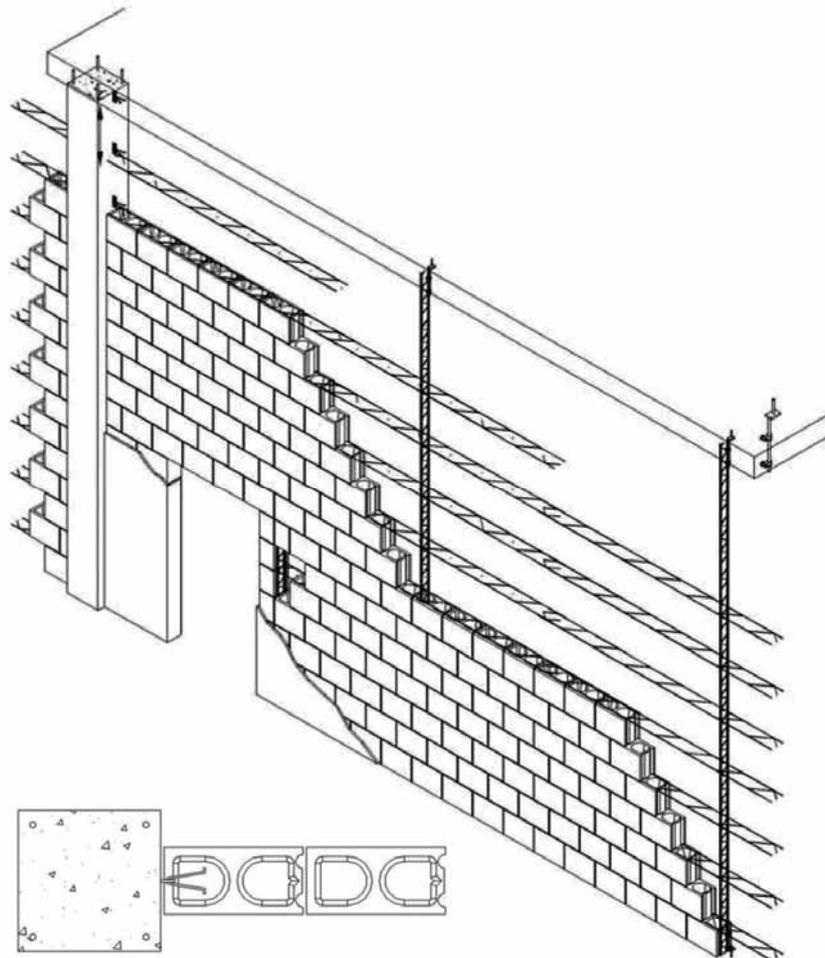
Perspectiva de muro de 1 hoja de partición de gran altura, con el Sistema de Albañilería Integral. Detalle del muro entestado con anclaje deslizante sólo en vertical (Z).
